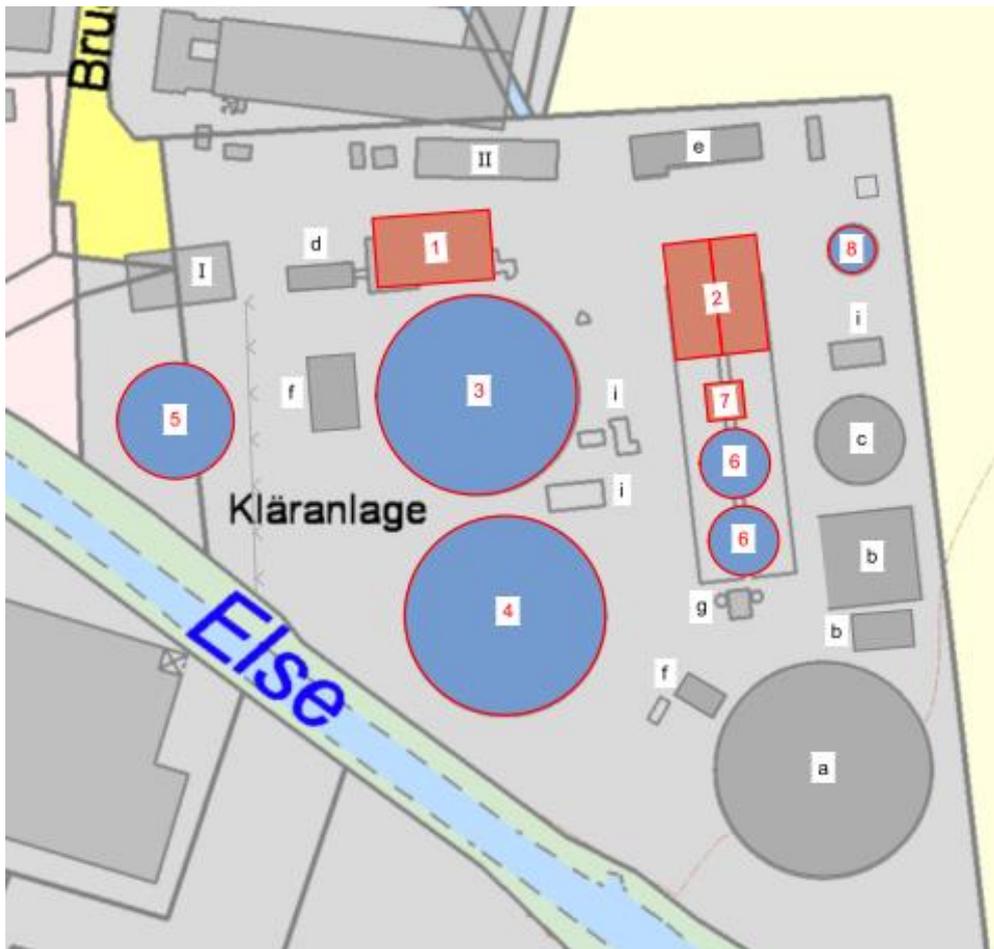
Lageplan Variante 2: Erweiterung Kläranlage Melle-Mitte
